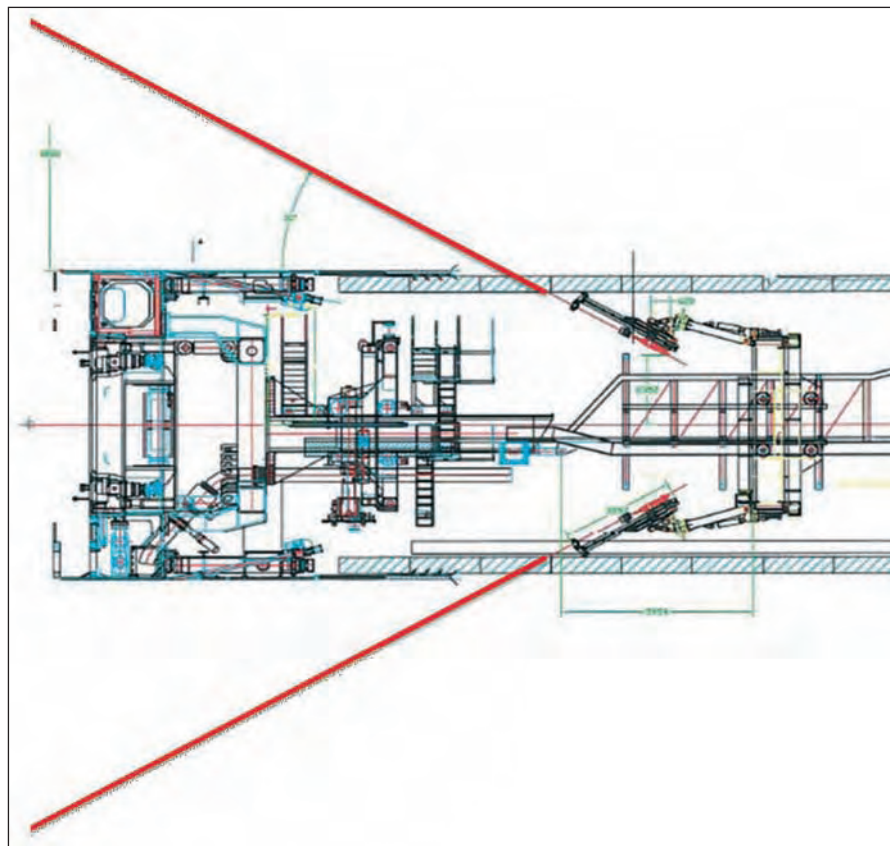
Forage à travers le revêtement pour injection autour du bouclier.
